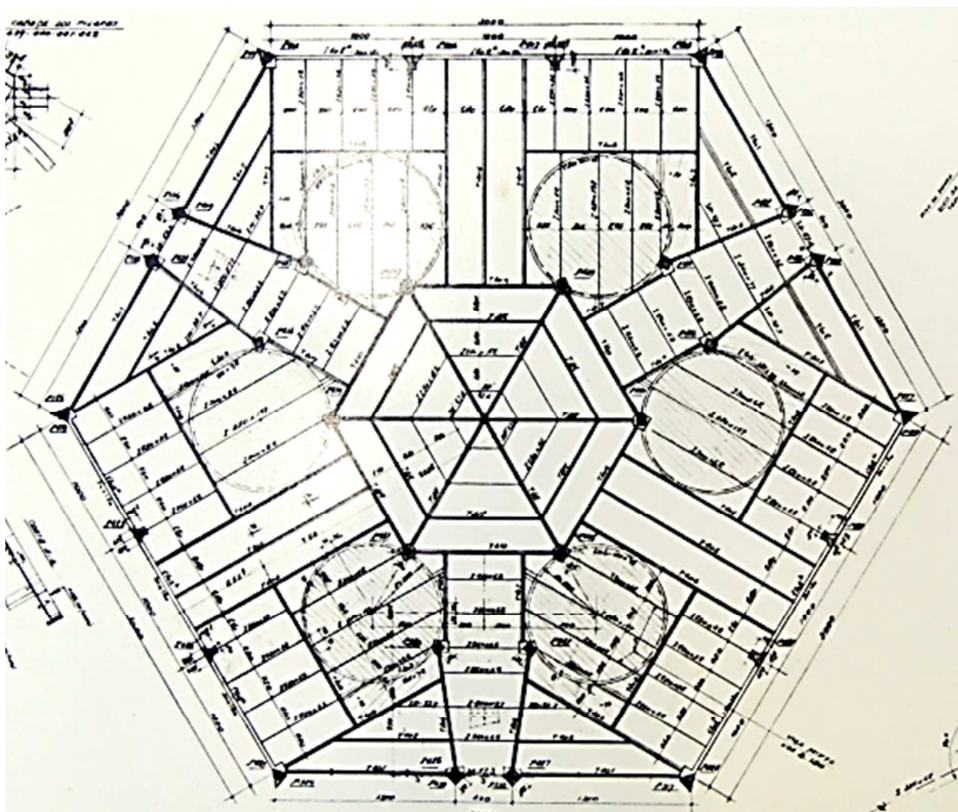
Sergio Bernardes, ESG, DF, 1970/74. Planta estrutural – fôrmas laje piso 2º pavimento. Fonte: Acervo Sergio Bernardes - NPD/UFRJ.
